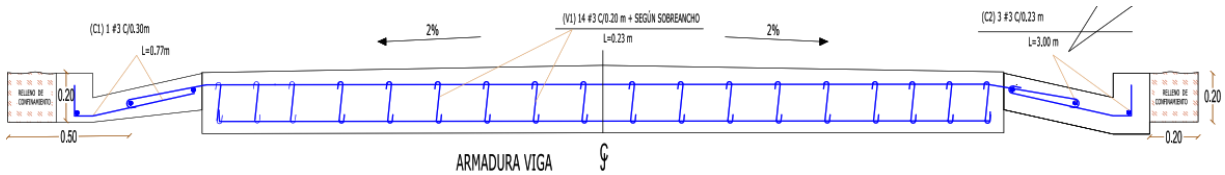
, Armadura aceros viga transversal Placa Huella con sección de cuneta tipo "L"
